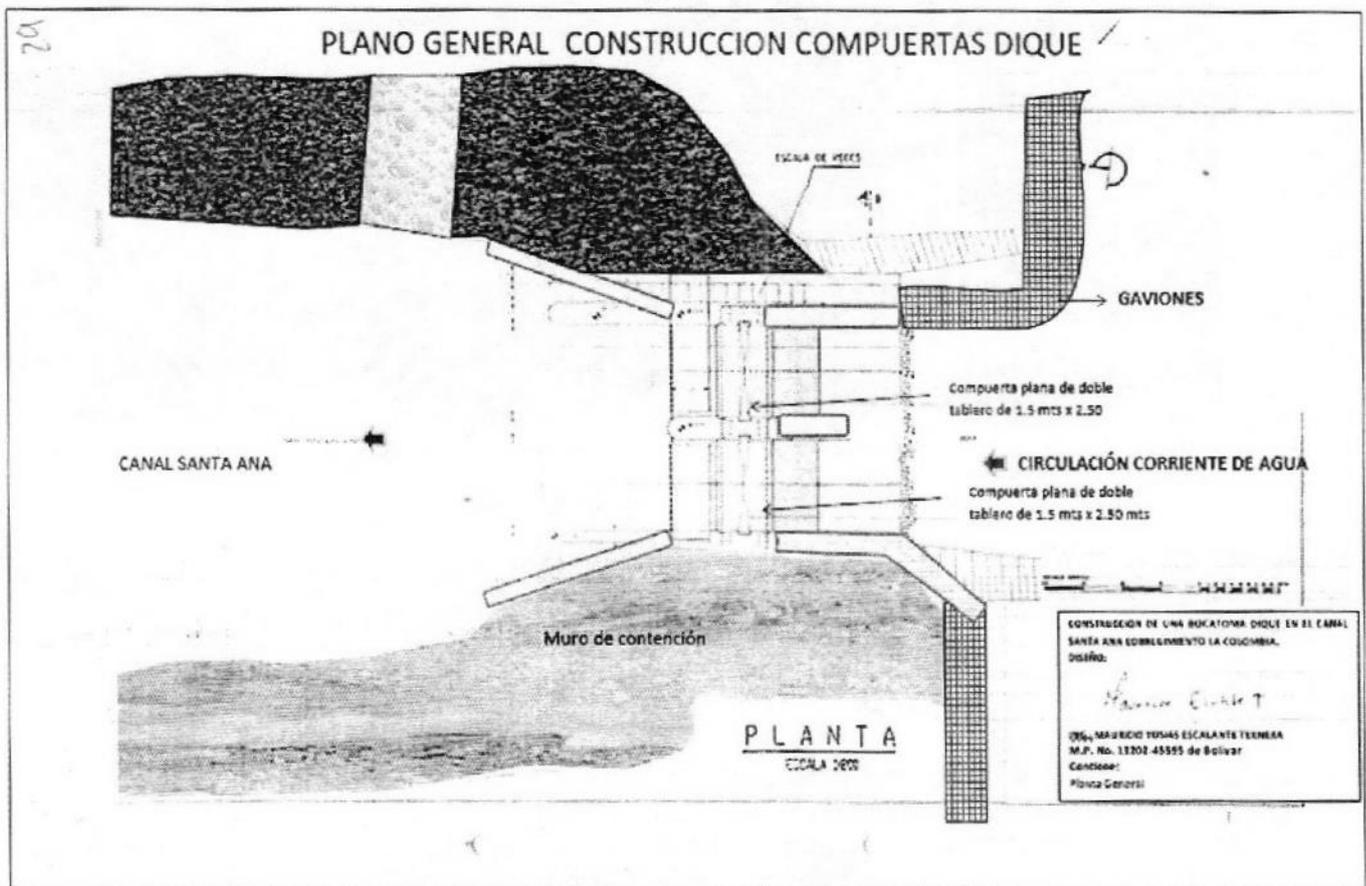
Planta muros de contención y aletas toma lateral canal Santa Ana. Fuente: Plano estructural solicitante
